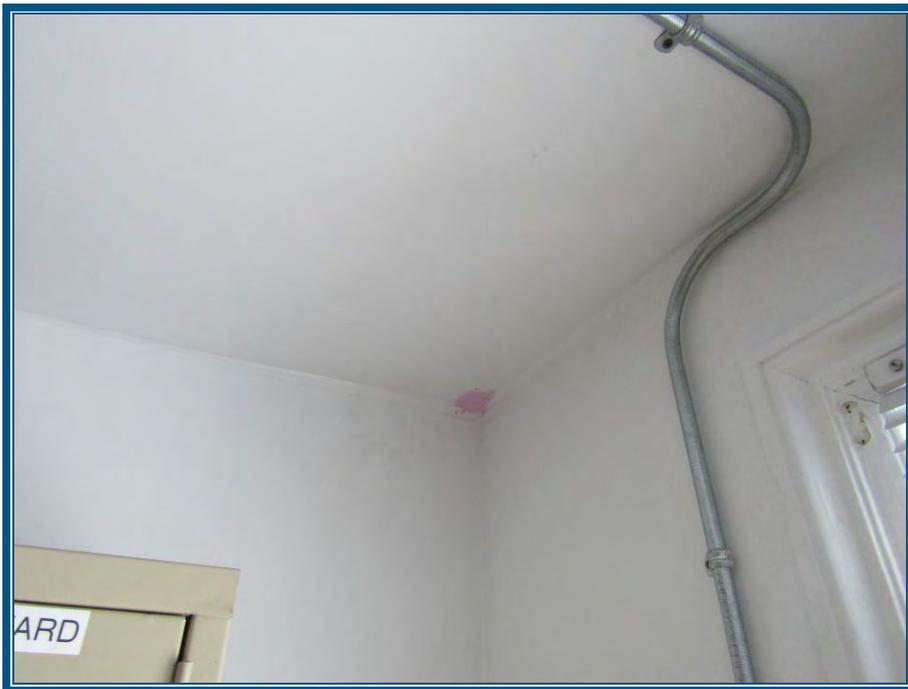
Murs et plafond de gypse dans le vestiaire à l'étage ne contiennent pas d'amiante
